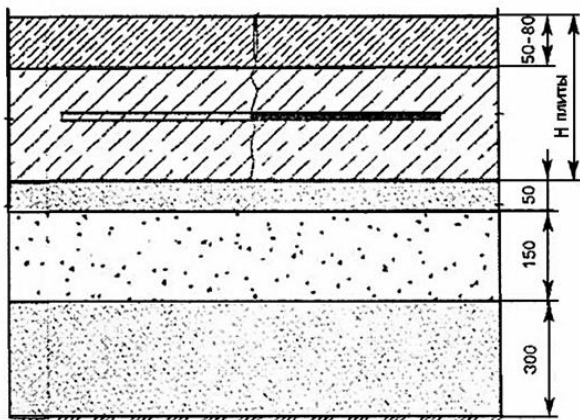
Двухслойная комбинированная железобетонная плита со слоем износа [5]
